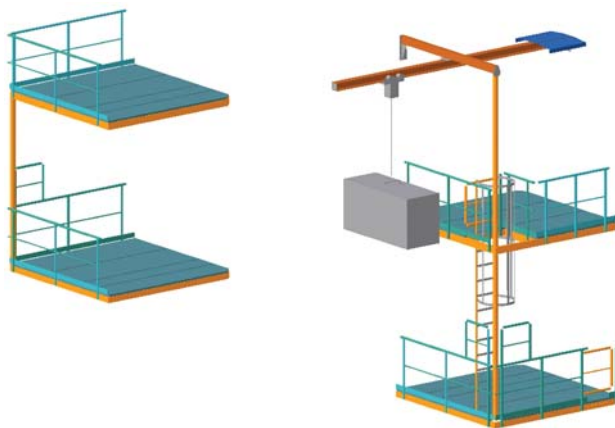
Площадки обслуживания и грузовая лебедка КВОУ
